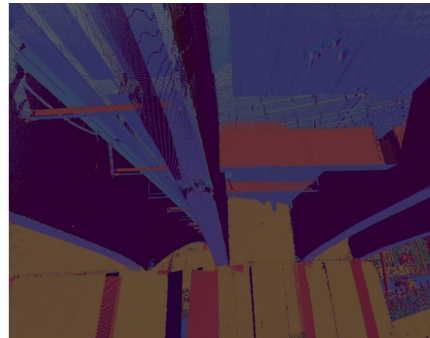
Armadura exposta em viga principal e parte inferior do tabuleiro da ponte
